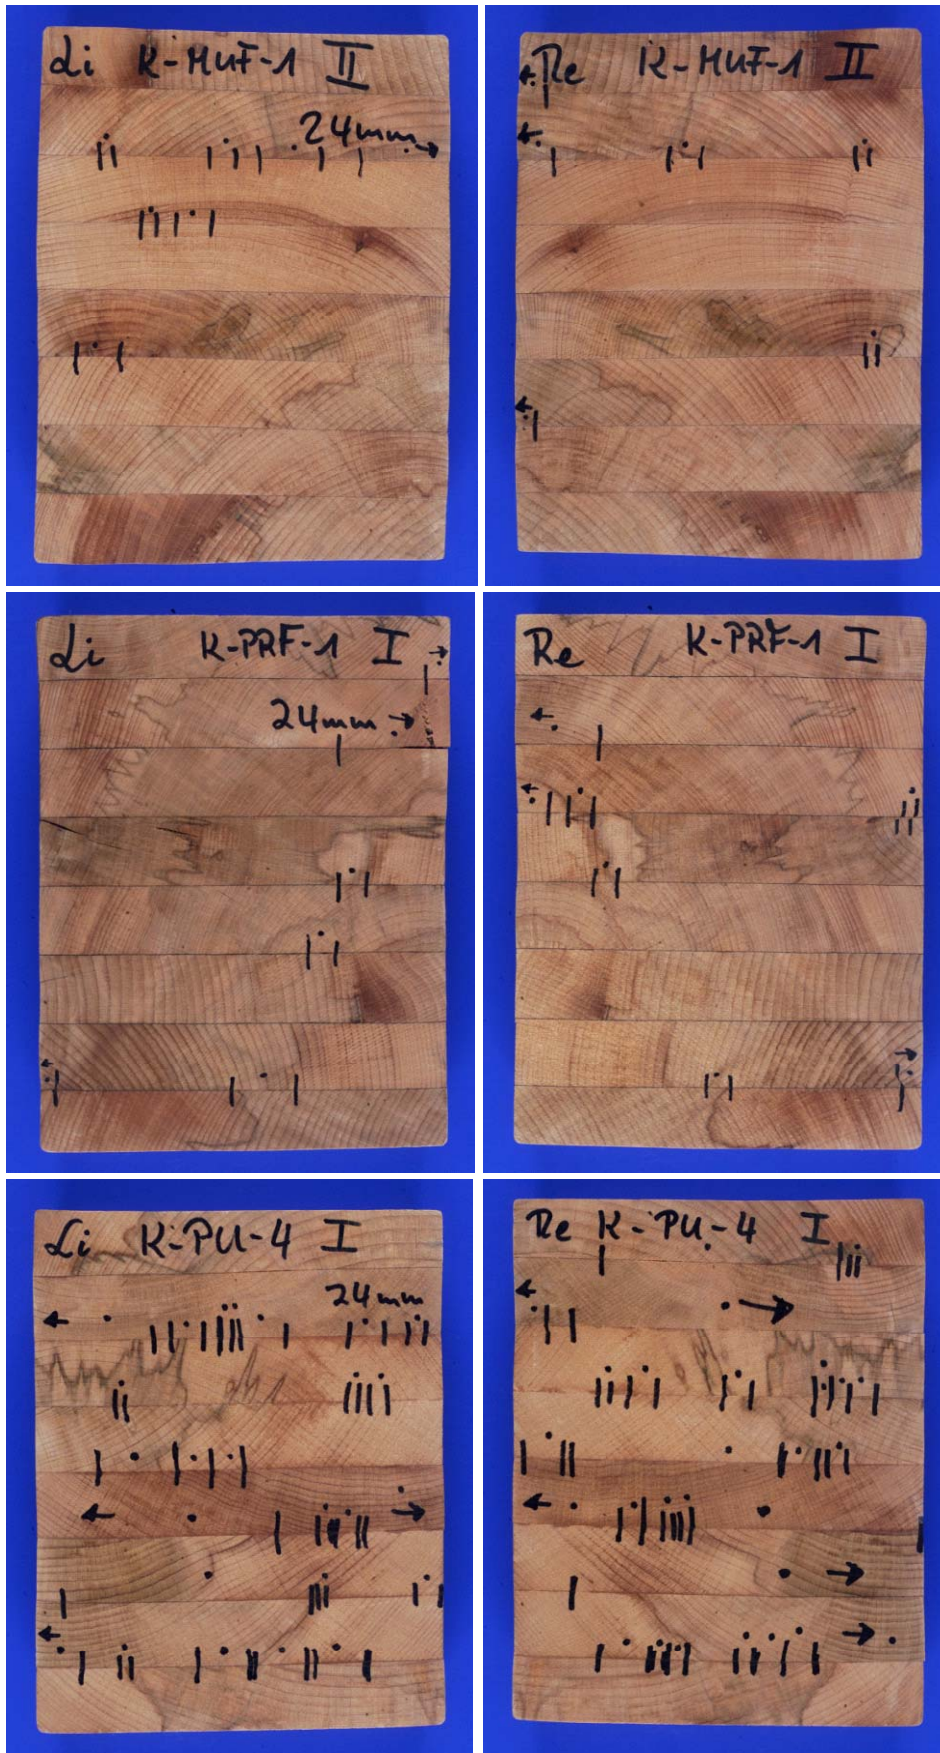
Delamierte Prüfkörper (Lamellenstärke 18 mm)
